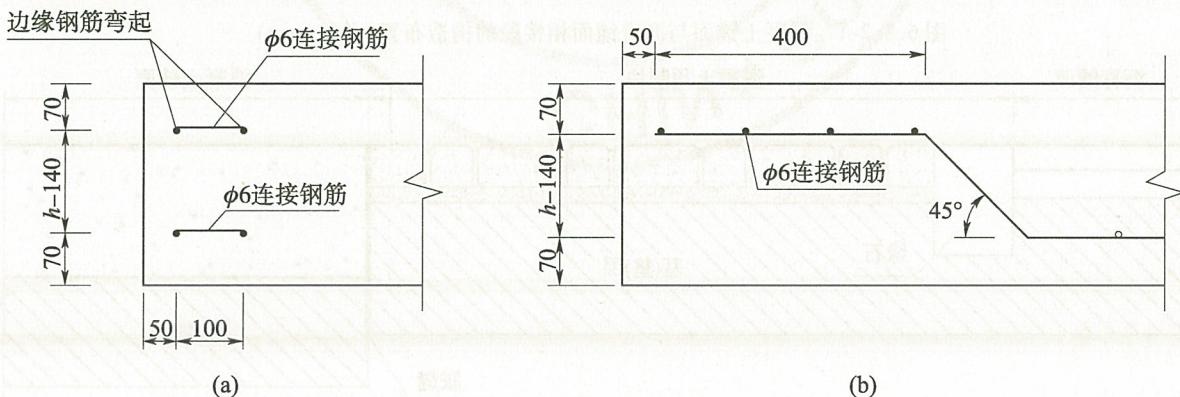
边缘钢筋布置 (单位:mm)
